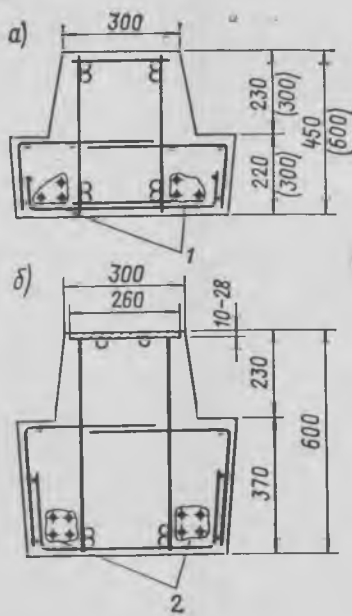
Поперечное сечение ригелей со стержневым (а) и листовым (б) армированием верхней зоны ригеля
